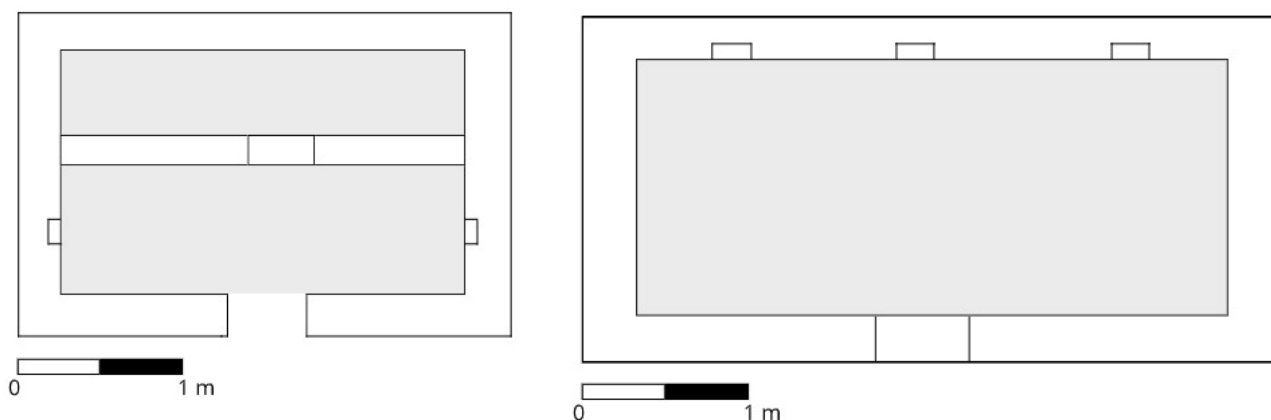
Dibujo esquemático de las formas de la planta arquitectónica.
